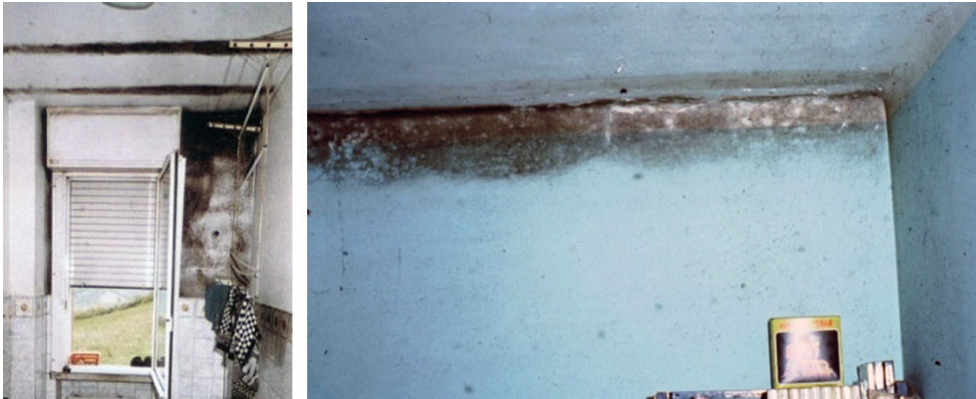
Ejemplos de manchas originadas por la presencia de moho. En la foto izquierda, marcando las viguetas de la cubierta plana y el muro exterior escasamente aislado. En la foto de la derecha, marcando la zona anexa al coincidente con el puente térmico del encuentro muro-exterior-forjado.
